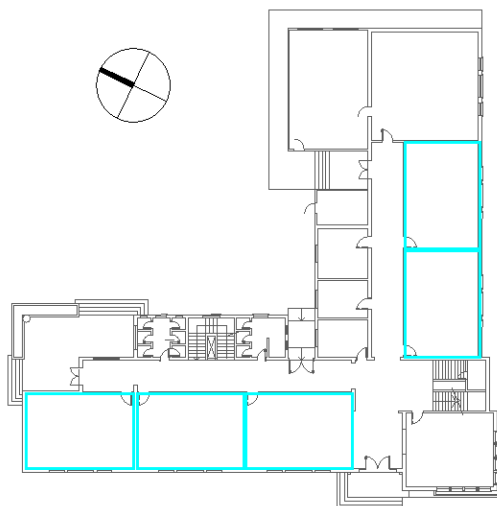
Planta baixa do 1º pavimento da escola Marques de Souza, ênfase na unidade formada pelas salas de aula.
